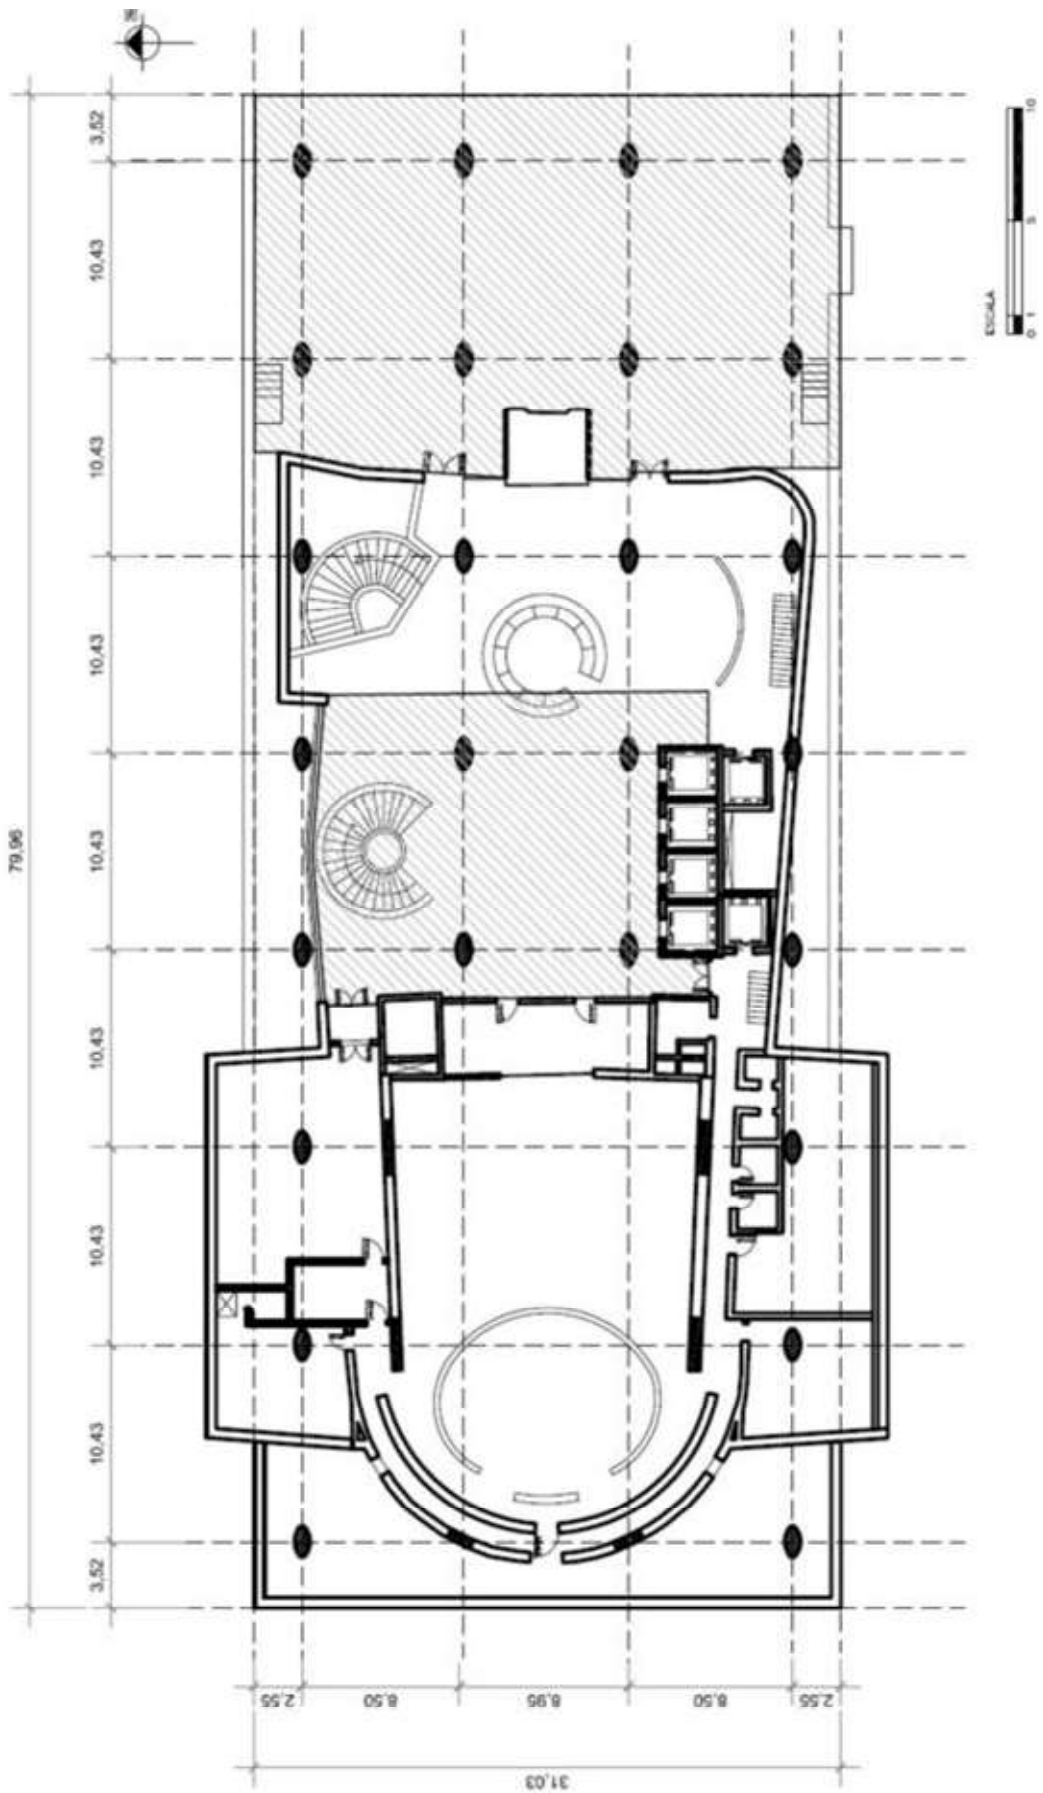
Modulação de projeto demarcada em redesenho da planta baixa térreo de Palácio da Justiça (1968).
